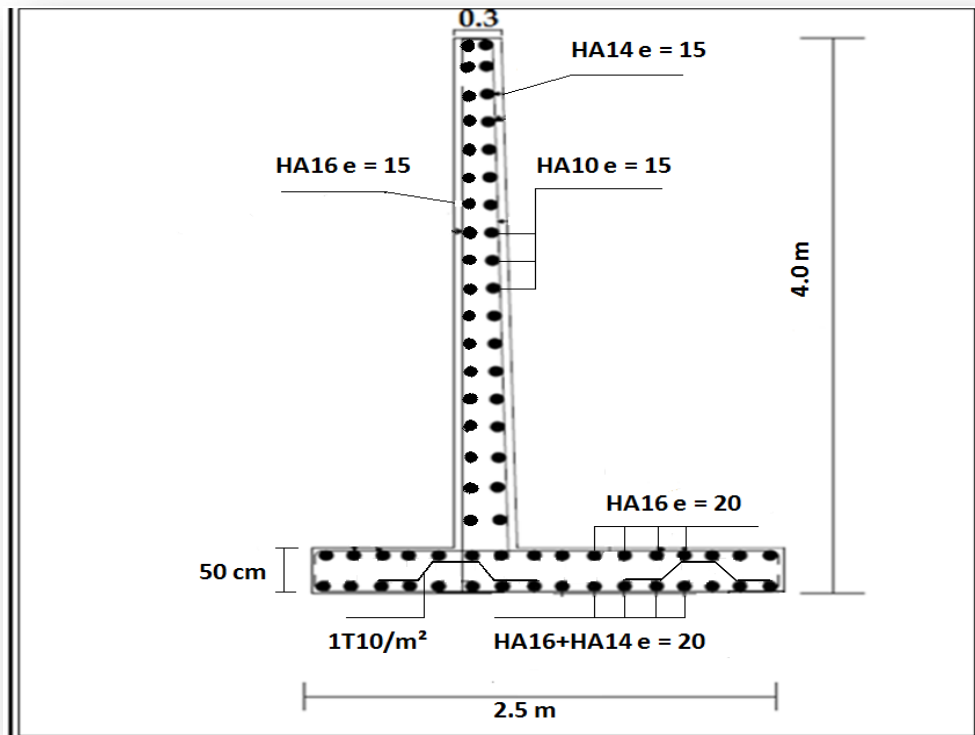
Schéma de ferrailage de mure de soutènement
